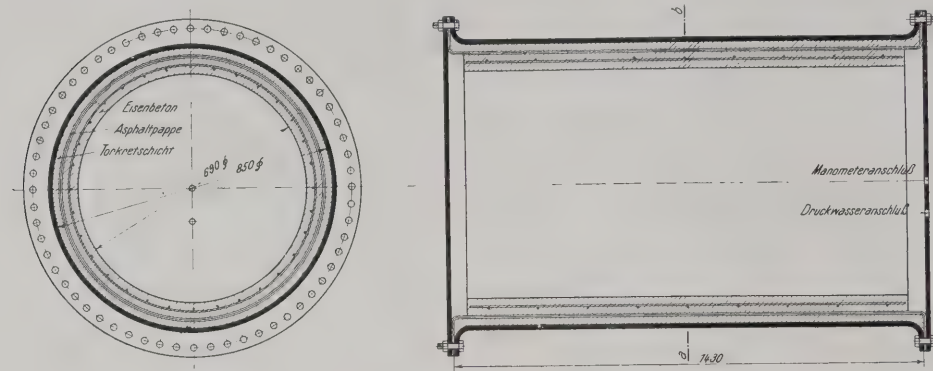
Versuch mit einer elastischen Dichtung bei unnachgiebiger Unterlage.
